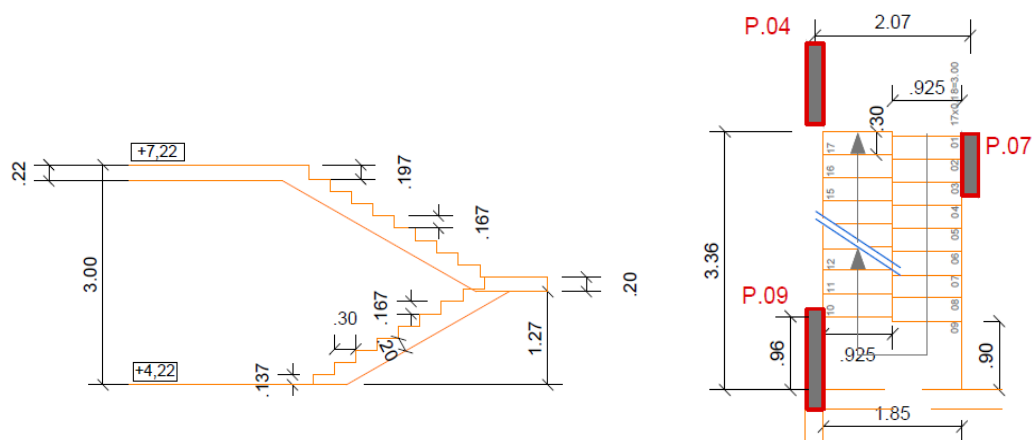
Planta e corte da escada do lote 6.7, piso -3 e -2.
